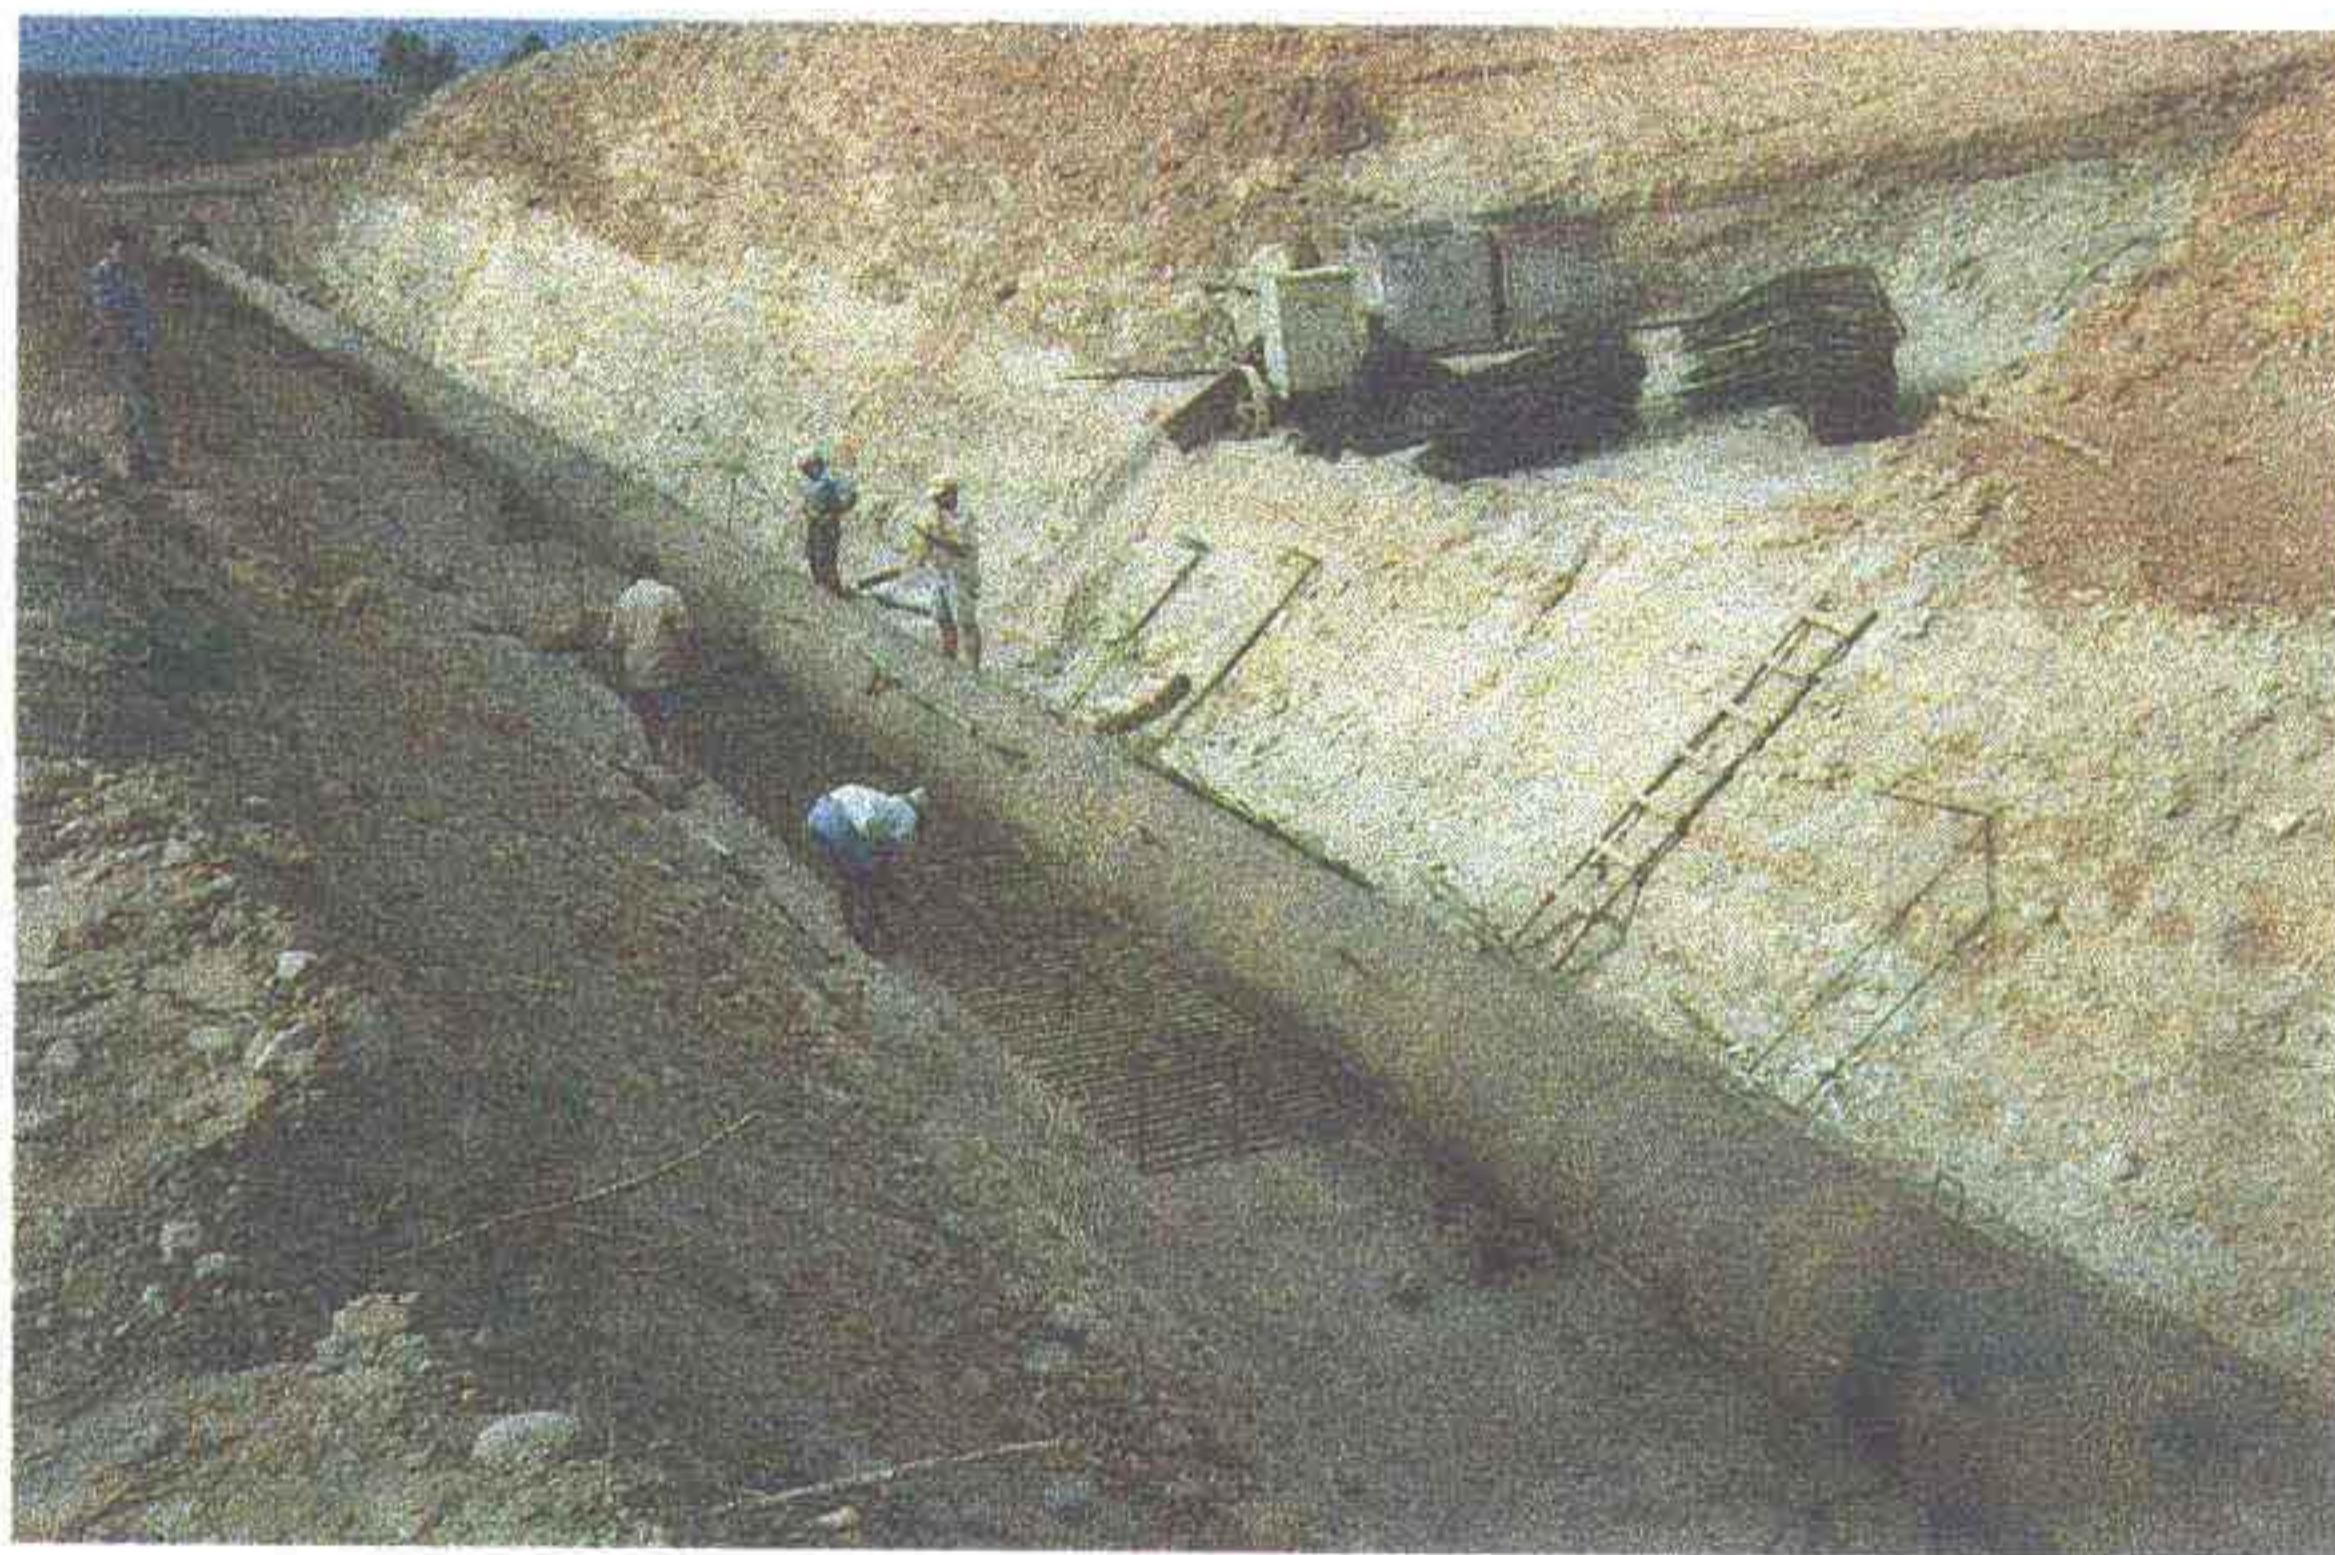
Armação da galeria no trecho que corresponde ao cut-off.
